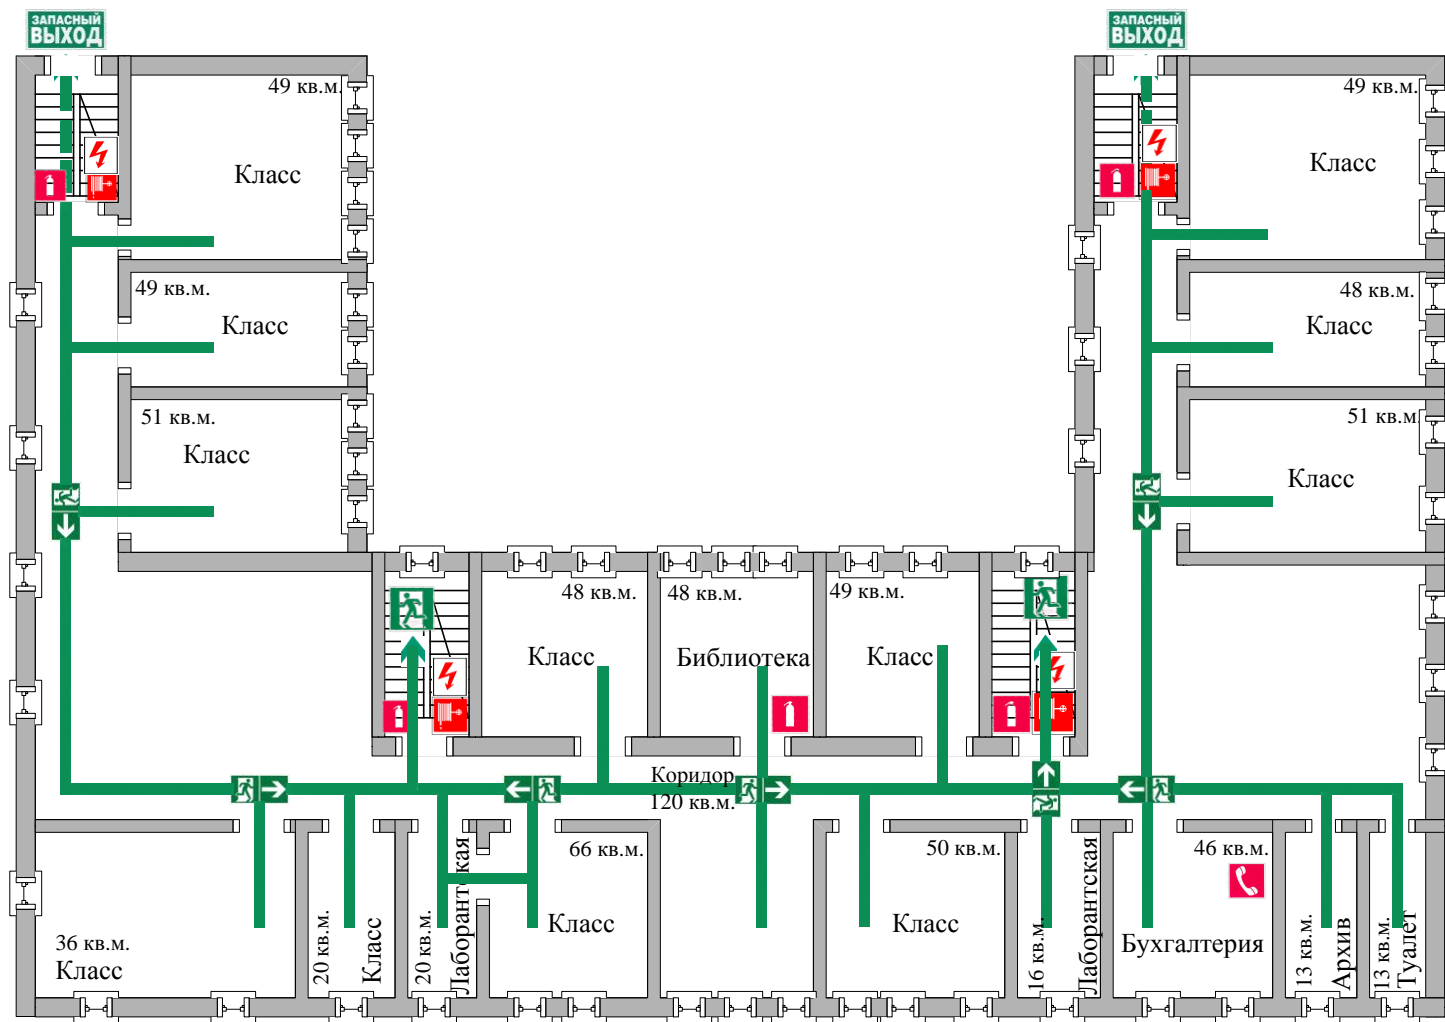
Схема помещений 3-го этажа гимназии
